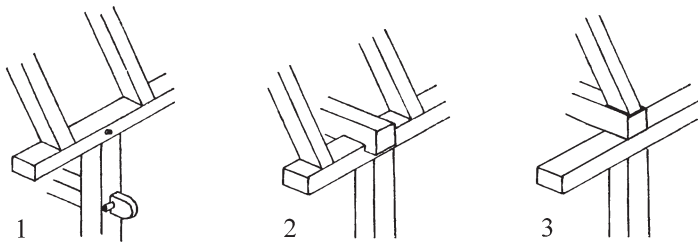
Ankerbalkenverzimmerungen. 1: durchgezapfter Ankerbalken, 2: aufgekämmtter Ankerbalken, 3: aufgelegter Dachbalken (nach BAUMGARTEN 1985, 34, Abb. 14b).
